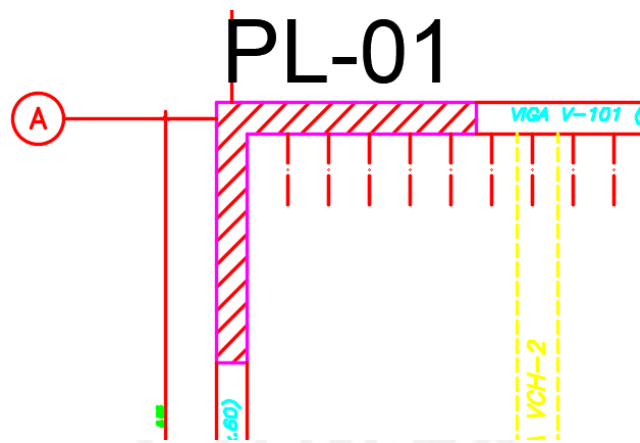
Placa superior izquierda de los ejes 1-A.
